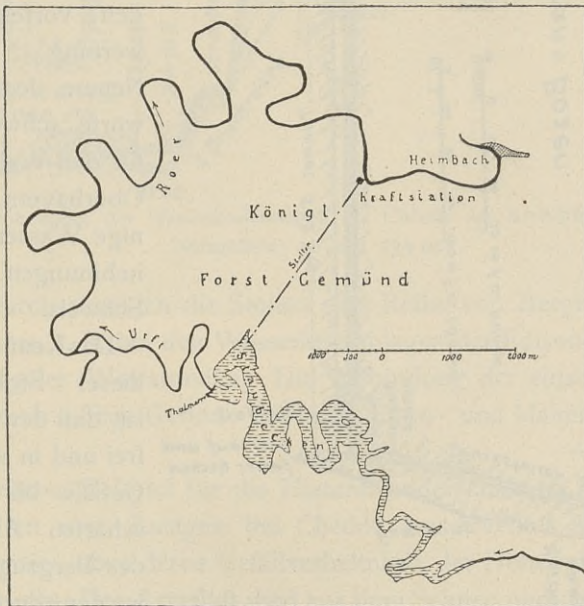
Lageplan der Urftalsperre mit Druckstollen und Kraftwerk bei Heimbach.
